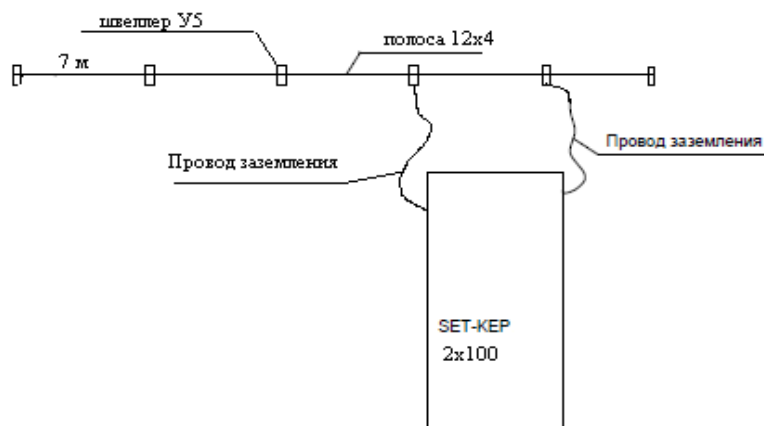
Схема сварочных работ при монтаже заземления
